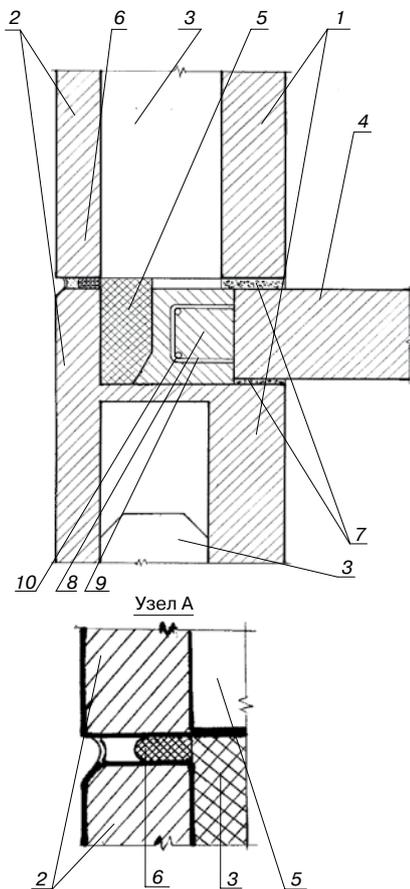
Поперечное сечение предлагаемого горизонтального стыка между продольными наружными несущими трехслойными стеновыми панелями (а) и узел А стыка с гидроизоляционным участком (б) (обозначения аналогичны рис. 1): 8 – железобетонный монолитный пояс; 9 – петлевые арматурные выпуски; 10 – непрерывные арматурные стержни в углах петлевых выпусков
